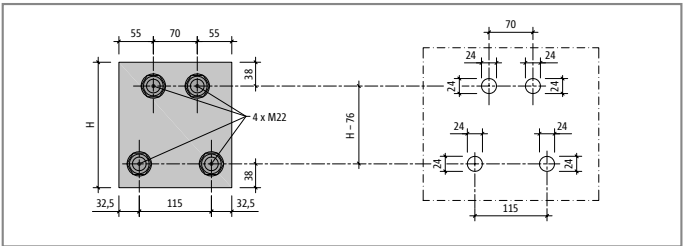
Schöck Isokorb® T Typ SK-MM2 mit Betondeckung CV28: Lochbild für die Schalungshilfe
